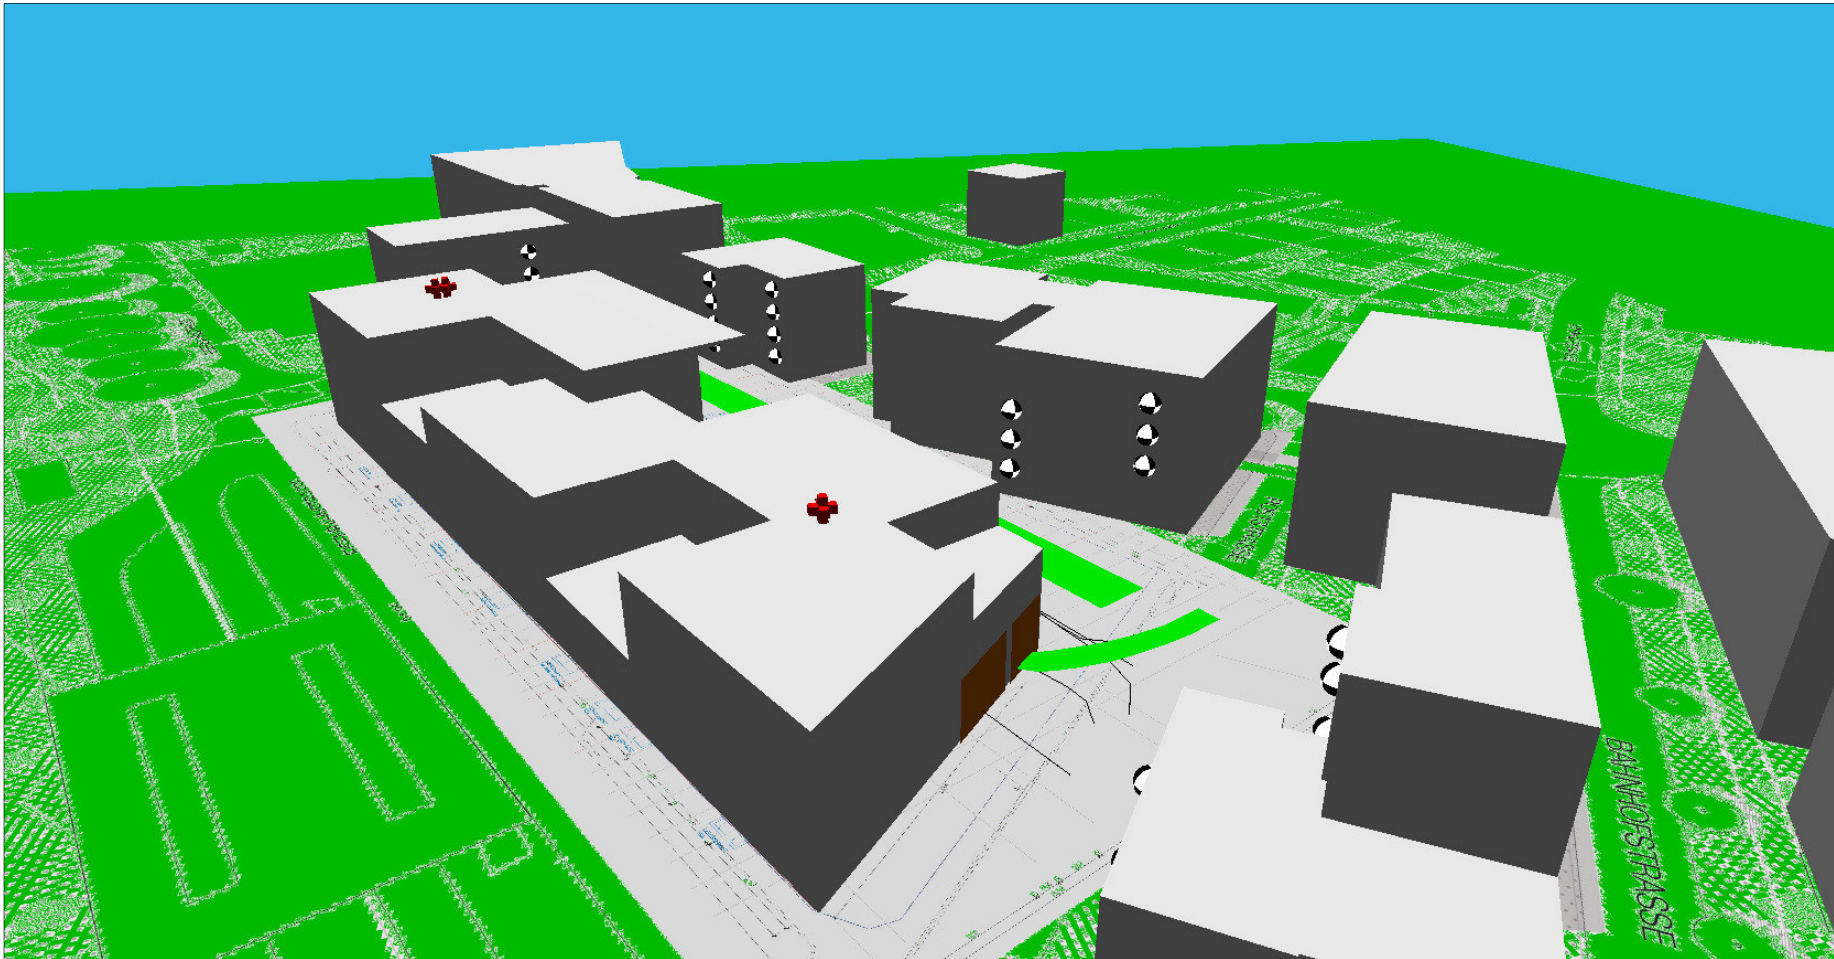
3D-Ansicht vom Bahnhofsareal in Richtung Eisenbahnstraße, Poststraße mit geplantem Wohn- und Geschäftsgebäude
